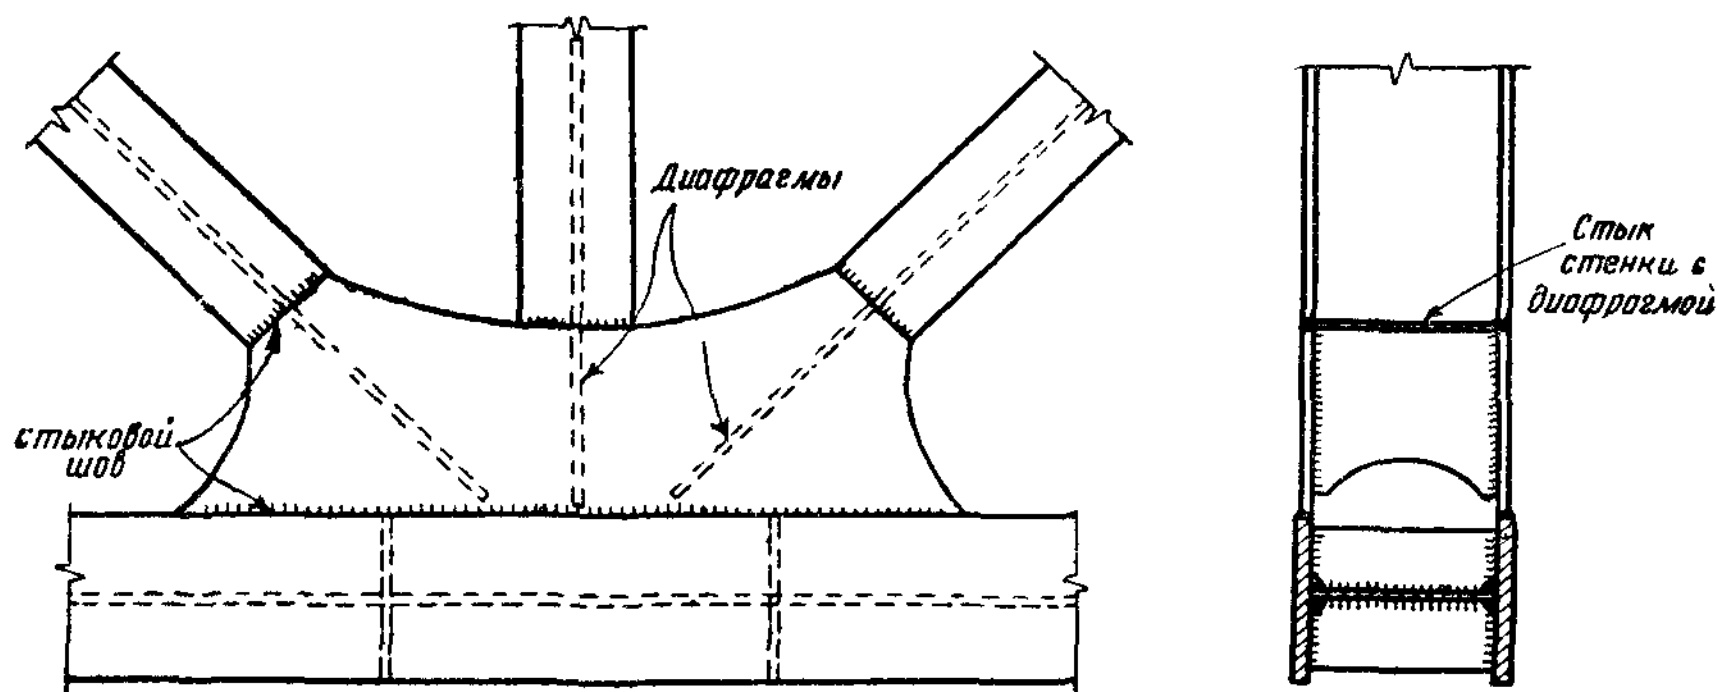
Узел сварной фермы при приварке уширений к элементам пояса
